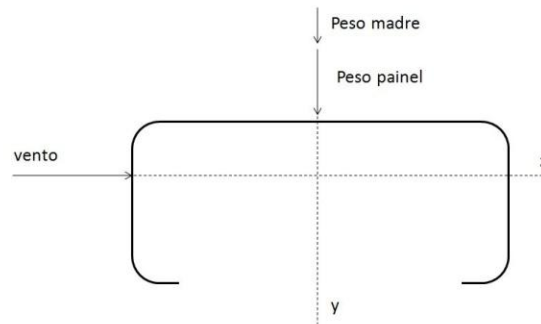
Esquema das cargas aplicadas nas madres de fachada
